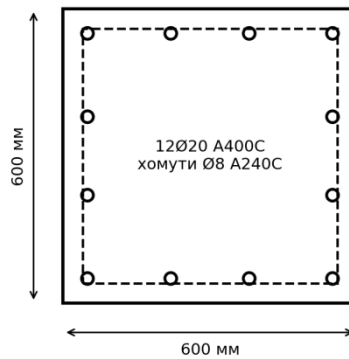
Схема армування поперечного перерізу колони 600х600 ММ
